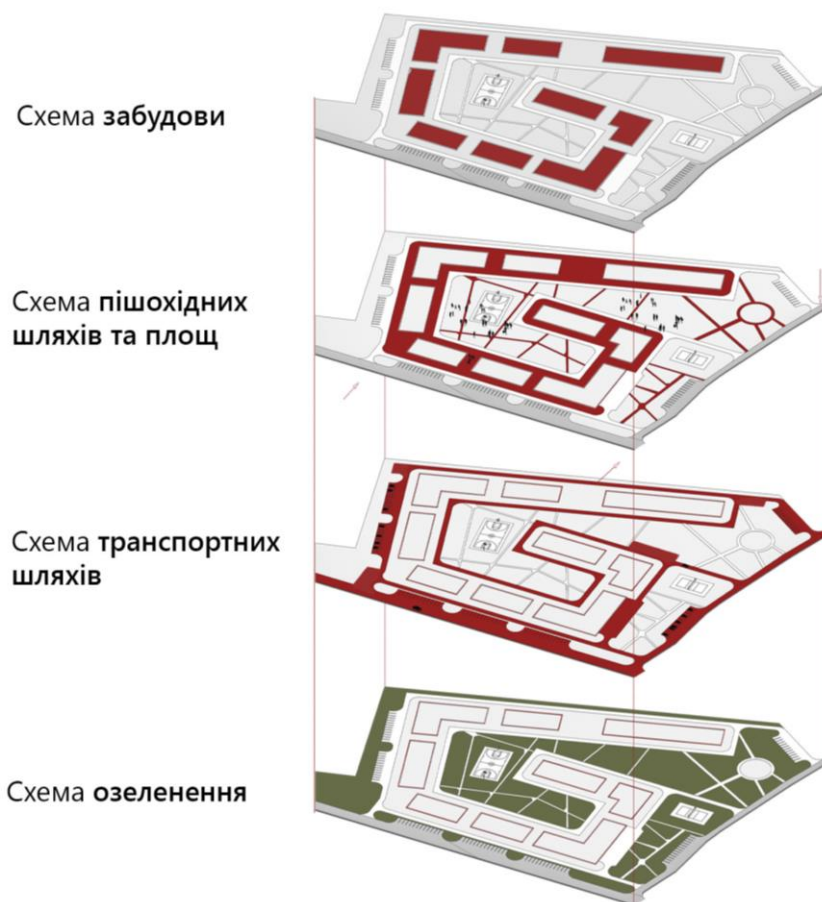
Схема функціонального зонування генерального плану.
